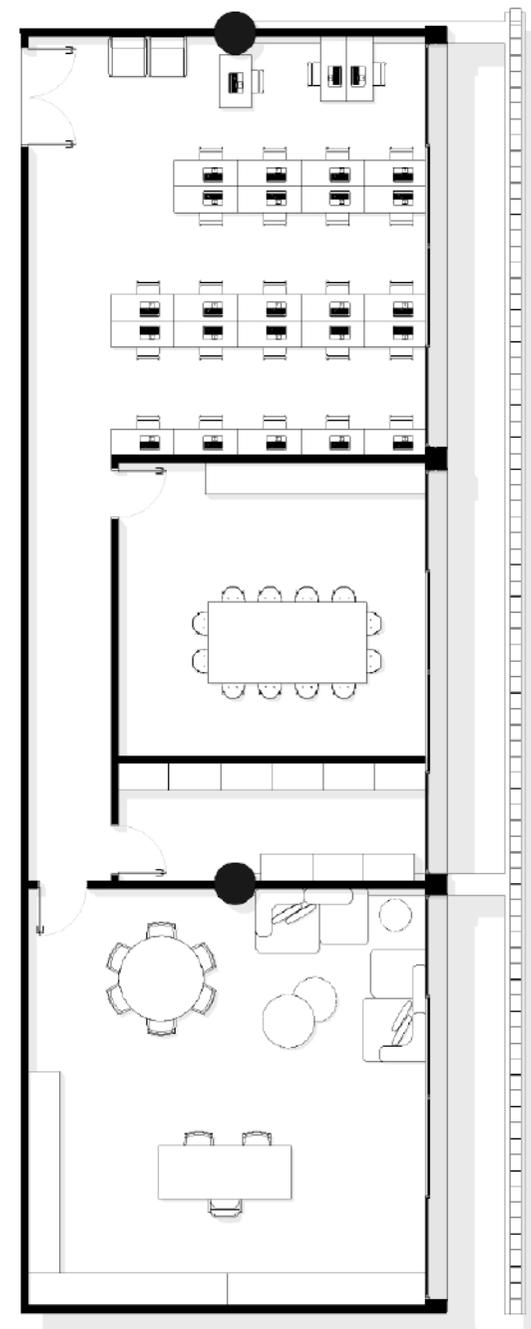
Planta baixa da disposição dos módulos de secretaria. Fonte: autoral, 2023.
